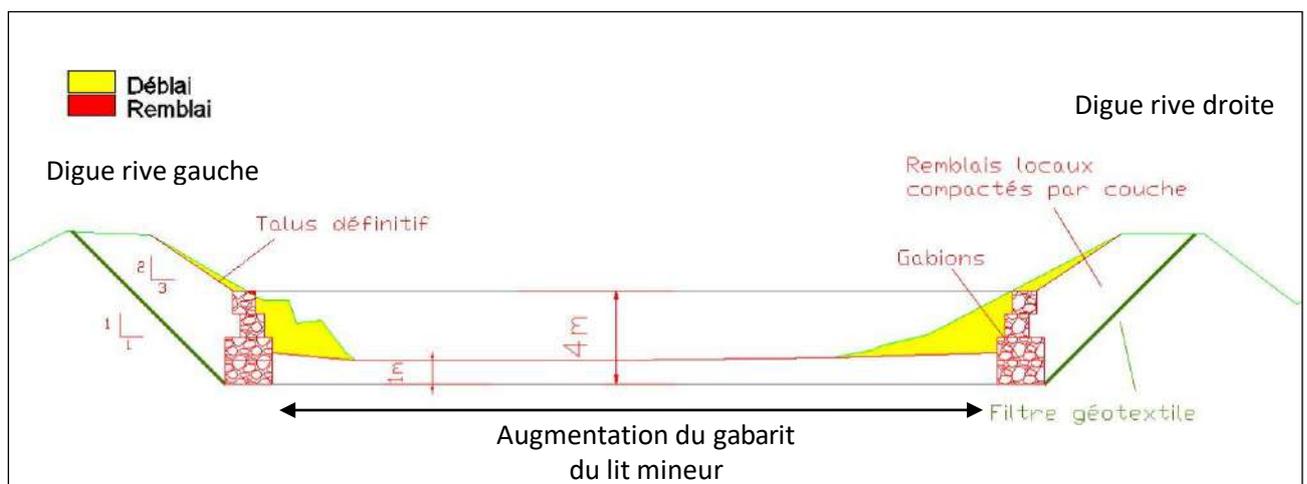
Coupe type de la protection des digues dans la traversée de Bollène
